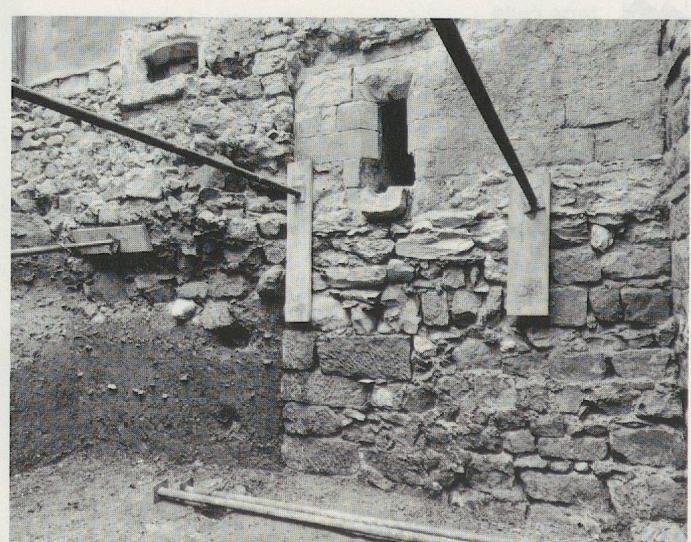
La cour haute: la façade nord de la cage d'escalier.
